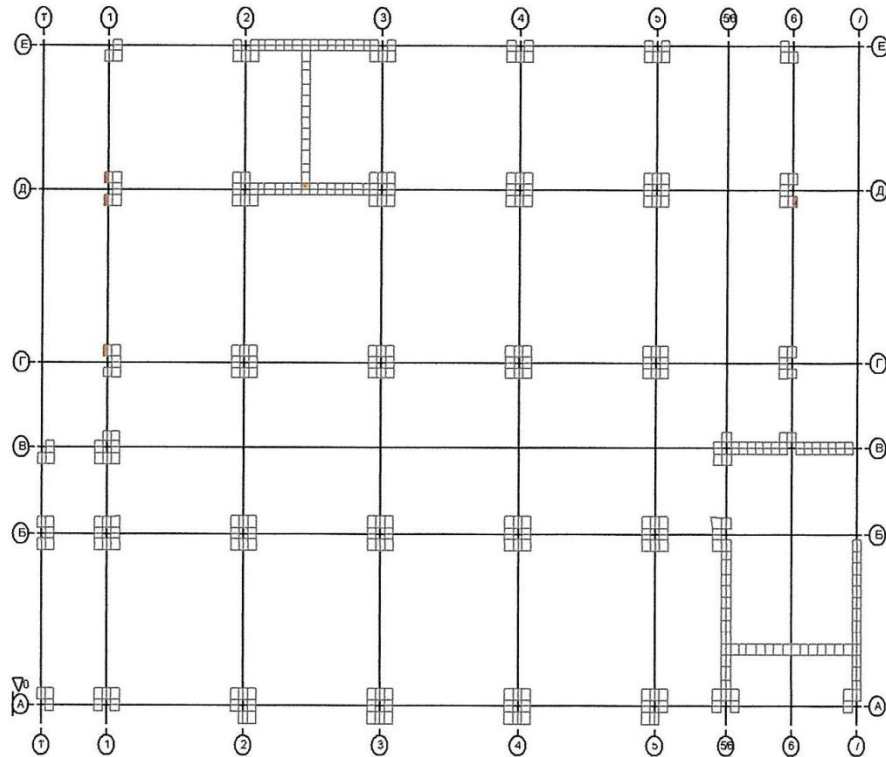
Поперечна арматура у напрямку вісі Y (ASW2) у капітелях і ригелях
